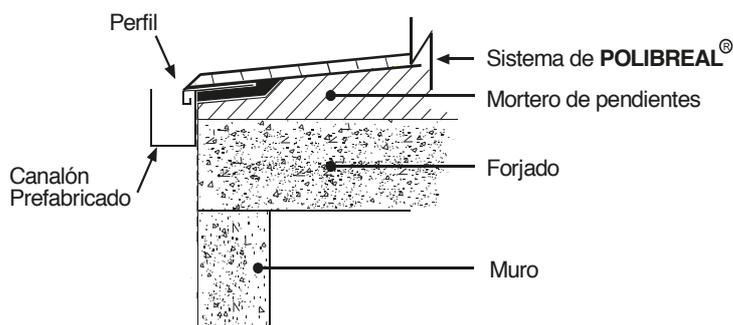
Entrega del sistema POLIBREAL® al borde extremo de un faldón con perfil metálico y canalón
